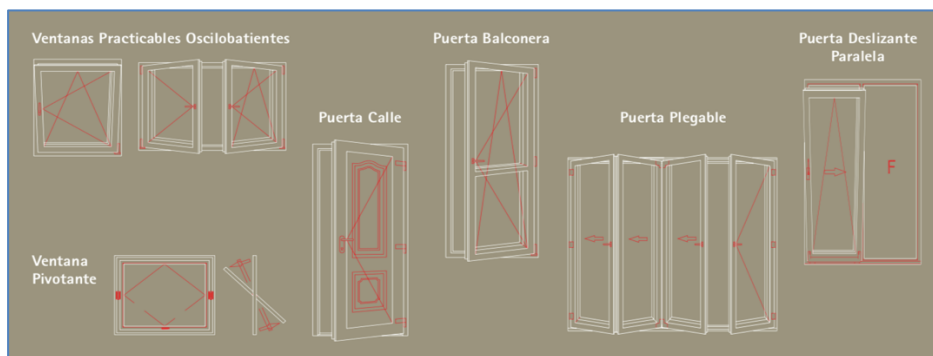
Tipología de la carpintería de PVC (Fuente: www.veka.es)
